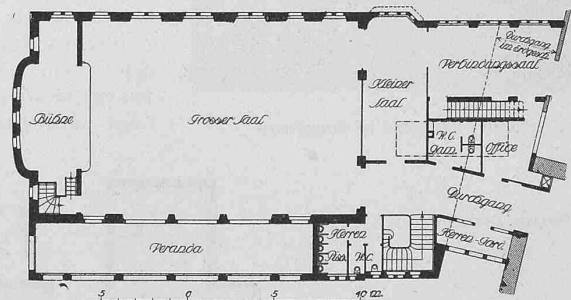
Grundriss vom I. Stock des Saalbaues. — 1:400.
